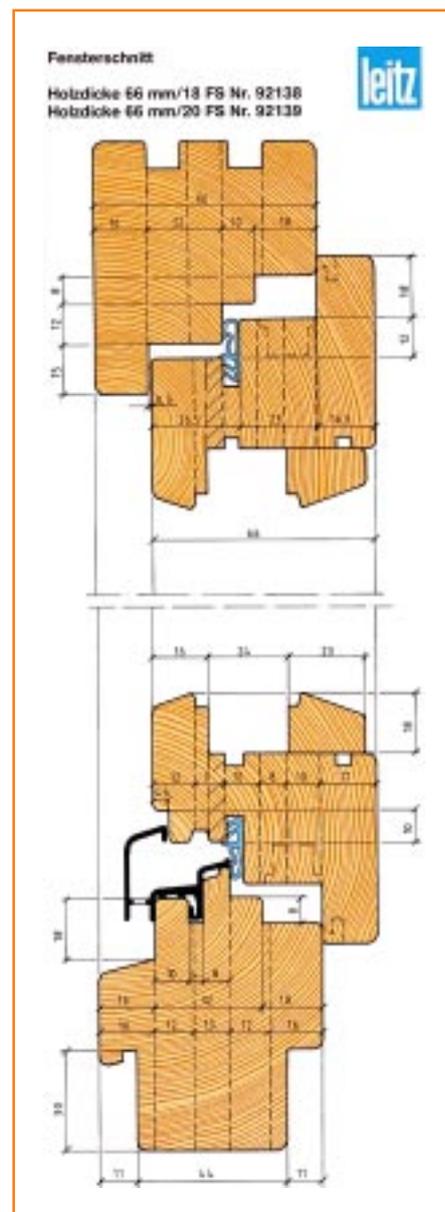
Holzfenster Deutschland: DIN 68 121 IV 68, werkzeugaugestimmt, die Details sind genormt Zeichnung: Leitz
